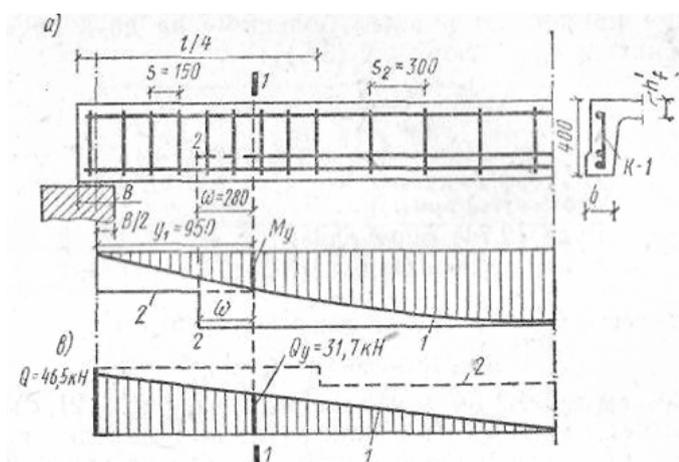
Определение места обрыва стержней в пролете продольных ребер; а – схема армирования; б – эпюры моментов; в – эпюры поперечных сил;
